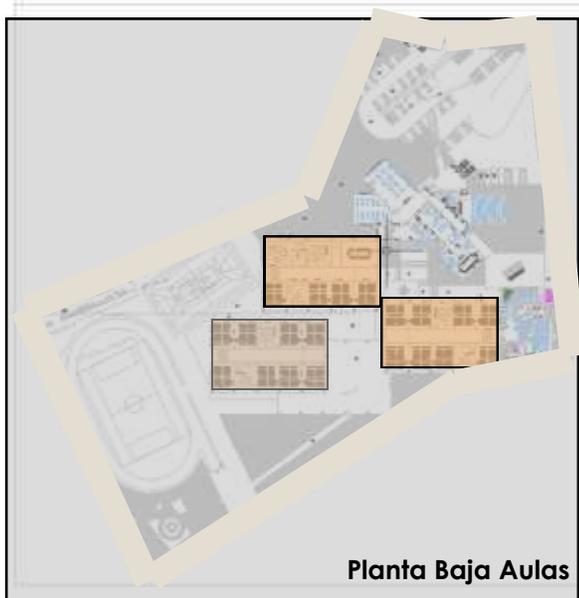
PLANTAS DE AULAS Elaboración Propia en AutoCAD 2010, 2013-08-15
